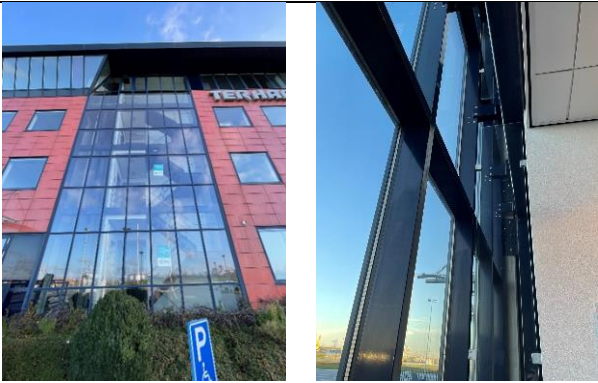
gevelpanelen verlijmd op betonconstructie en naden afgewerkt met een afdichtingsband.
